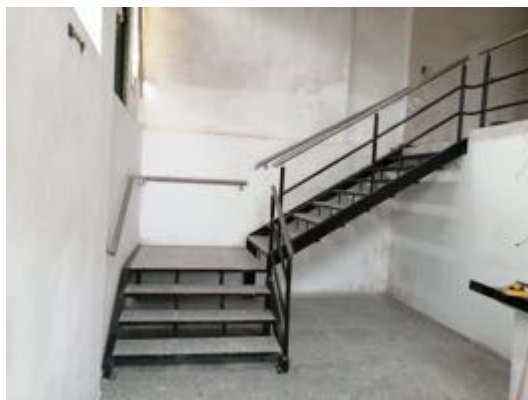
Escalera en acero prefabricada (Fuente propia)
